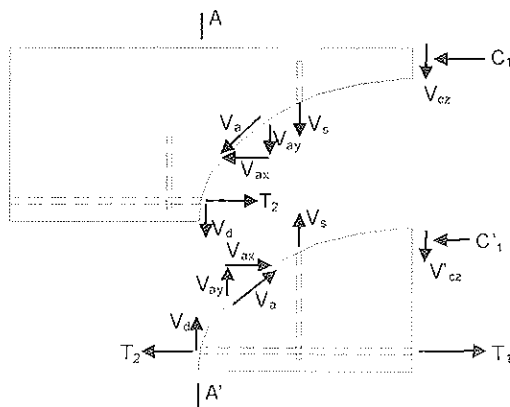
Fuerzas internas en una viga fisurada de hormigón armado con armadura a cortante (adaptado de MacGregor et al. 2000).
